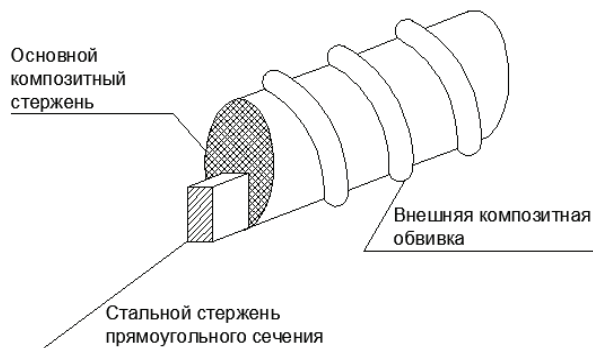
Вариант усиления композитной арматуры прямоугольной вставкой
